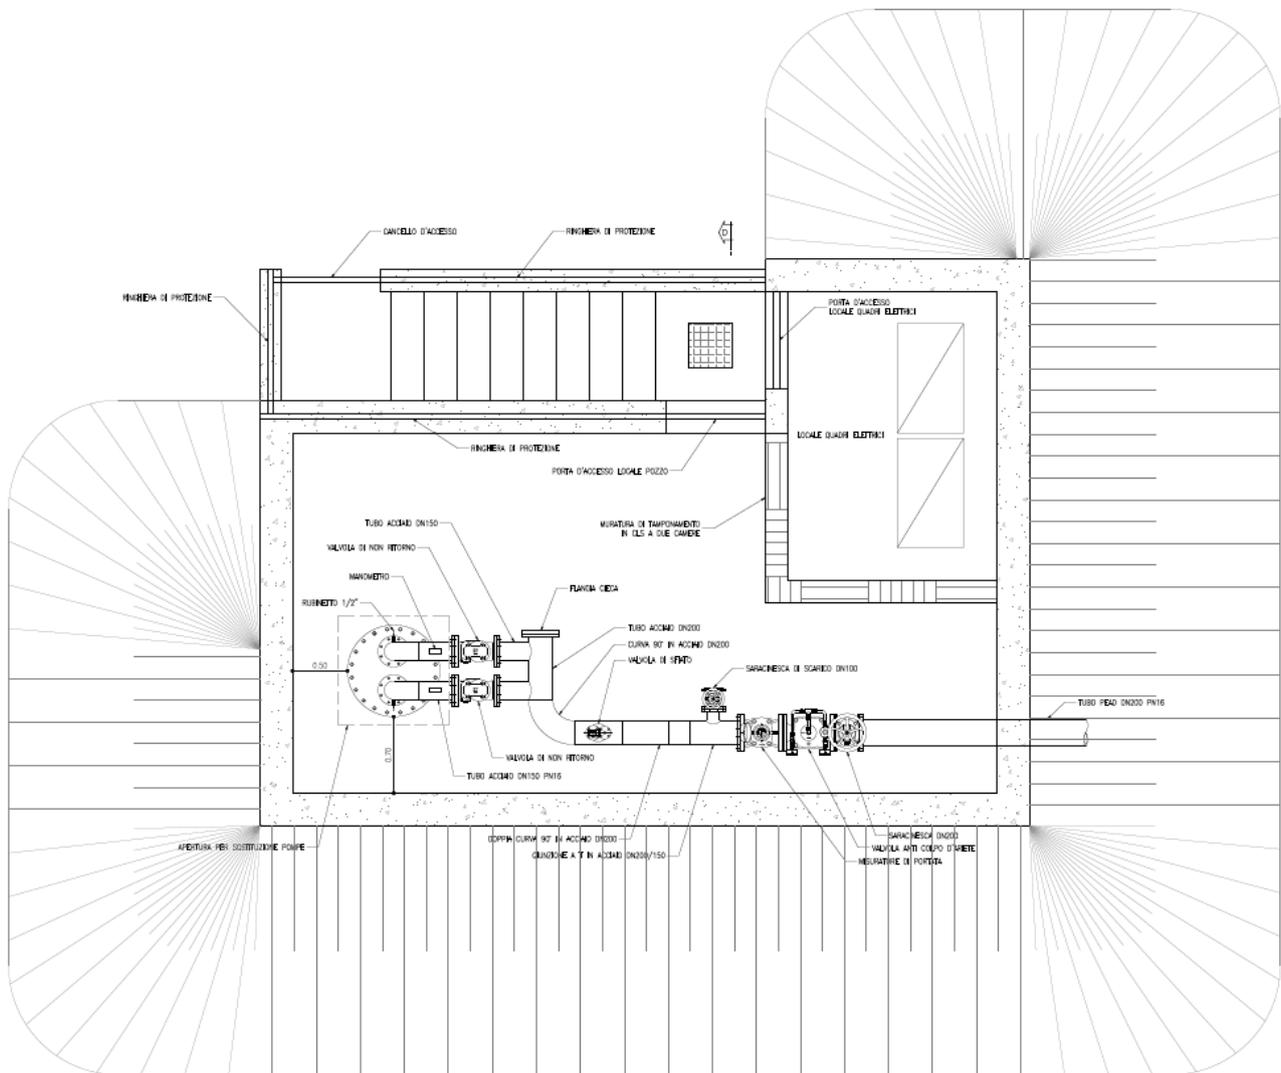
Estratto tavola IBOU1BEZZBZID0002009B, pianta manufatto pozzo; sorgente S2
